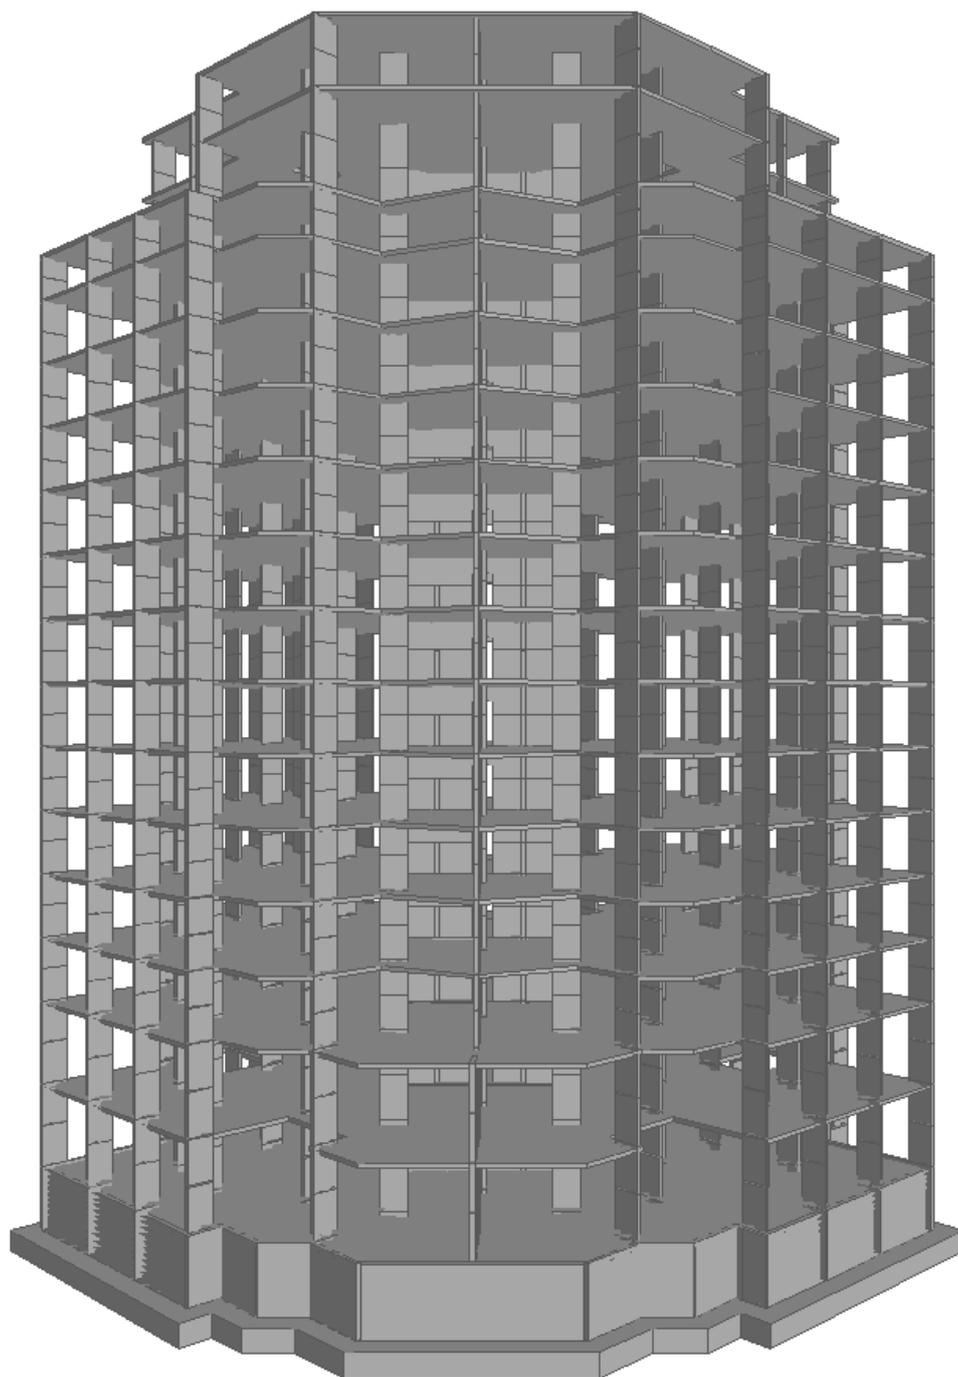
Общий вид каркаса здания со стороны главного фасада
